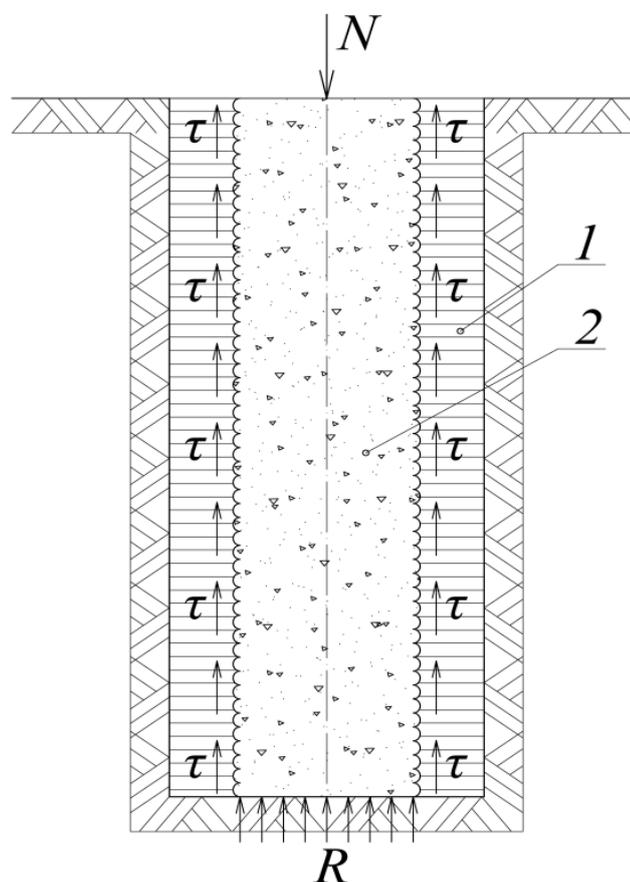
Схема к определению несущей способности сваи SFA (НПШ) по грунтоцементному основанию
